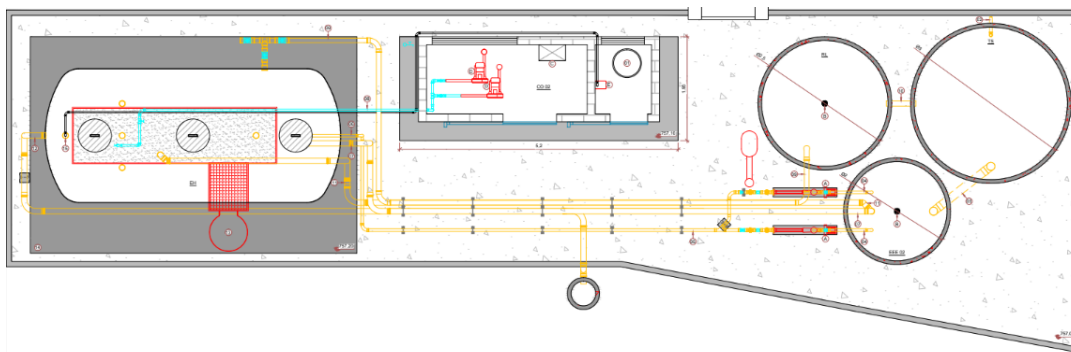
Layout padrão sistema FAS “ETE Horizontal 50m³/dia”
